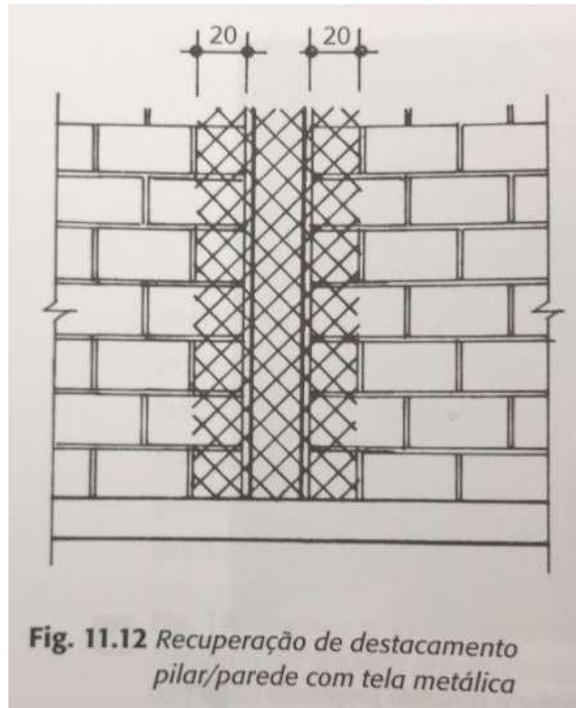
Recuperação de destacamento pilar/parede com tela metálica
